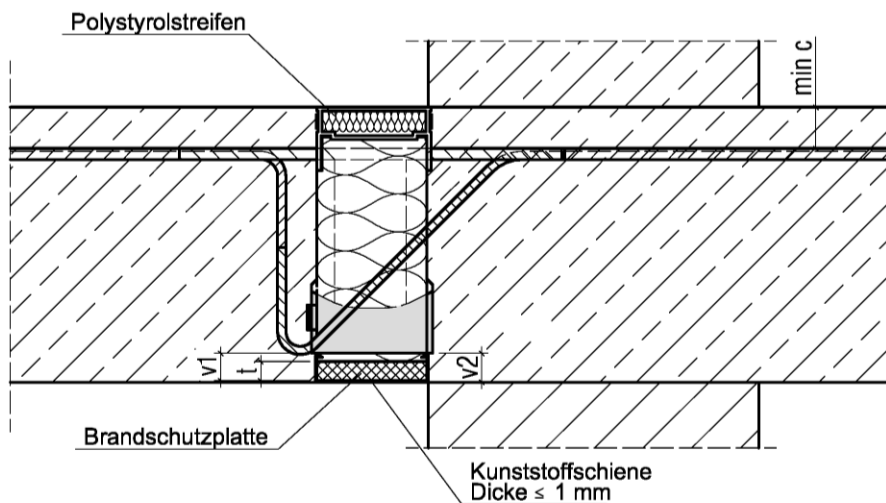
Schöck Isokorb® Typ K und Typ KF (Ausführungsvariante B) gem. Abschnitt 3.1.2
